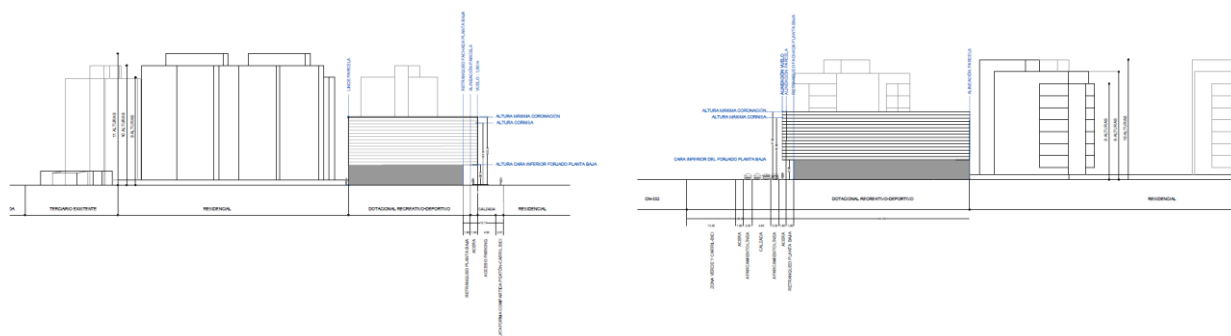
Alzados de uso deportivo en parcela B (Modificación de plan de reforma interior E-07, alternativa 2, 2021)
